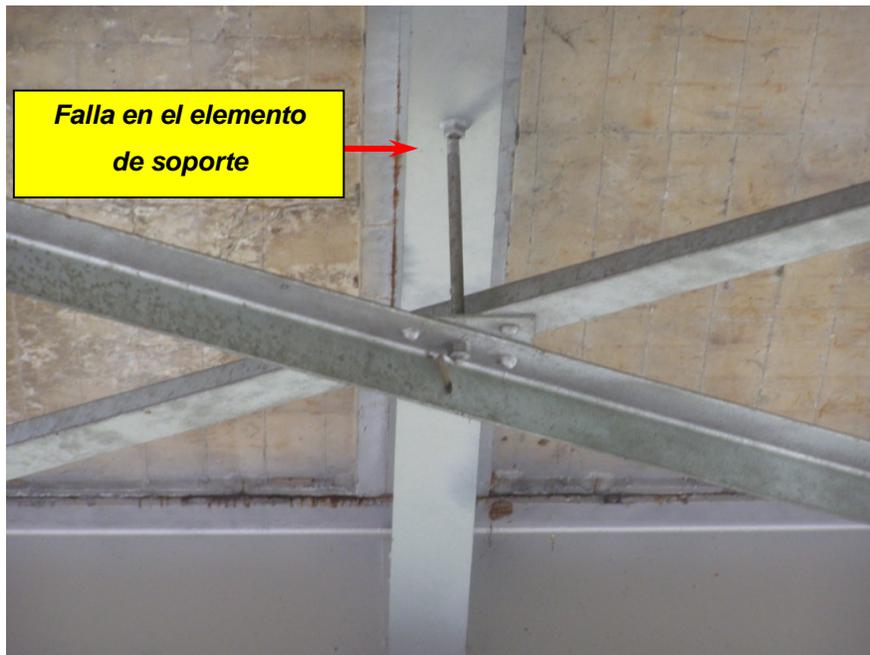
Desconexión del soporte del arriostramiento inferior bajo la losa.
